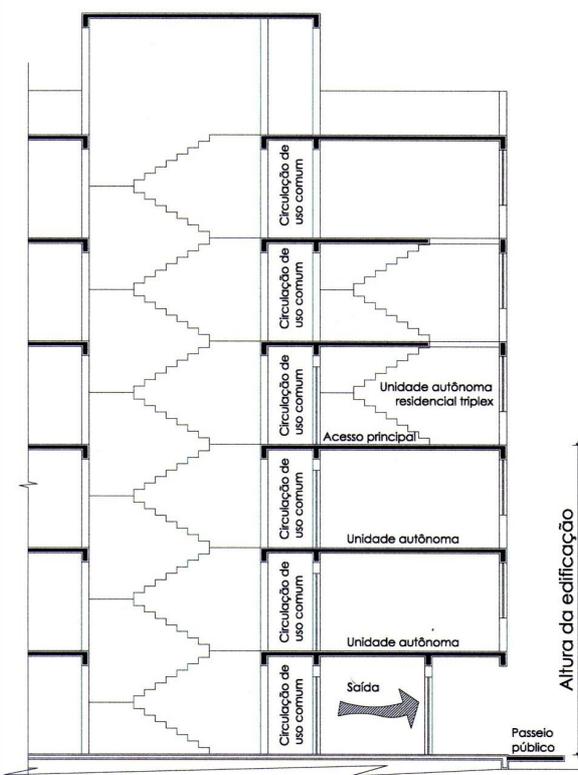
Último pavimento constituído por apartamento do tipo triplex.
